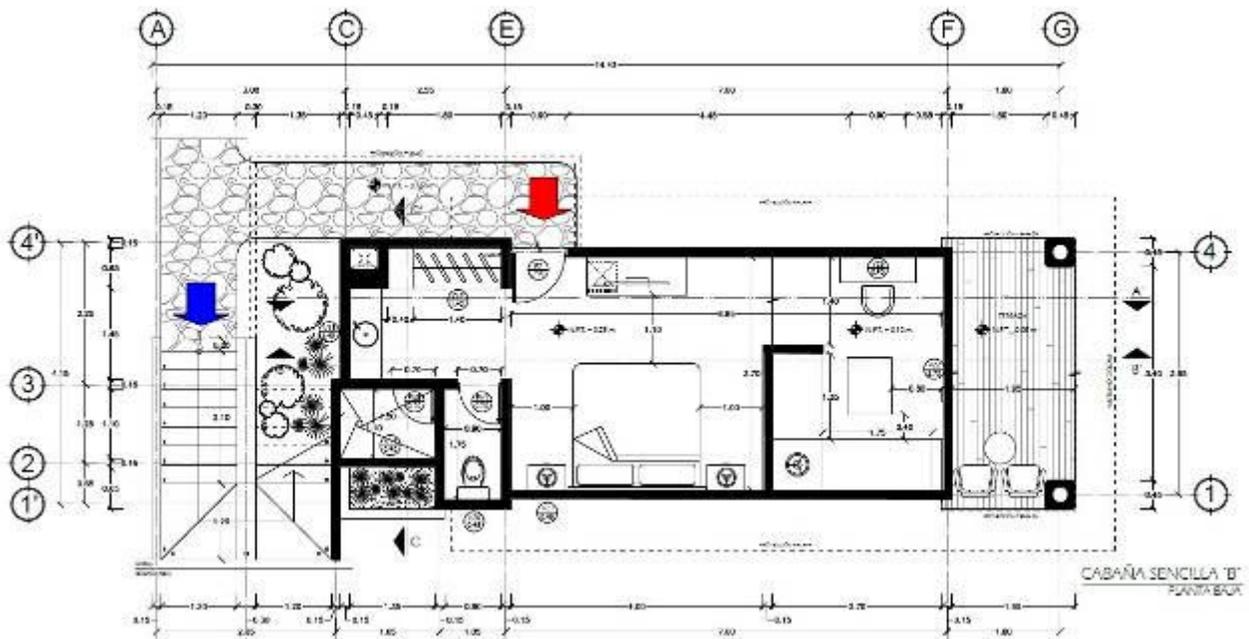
Planta de Cabaña Tipo B. (Flecha roja: Acceso directo en planta baja. Flecha azul: Acceso a escaleras para segundo nivel.)
